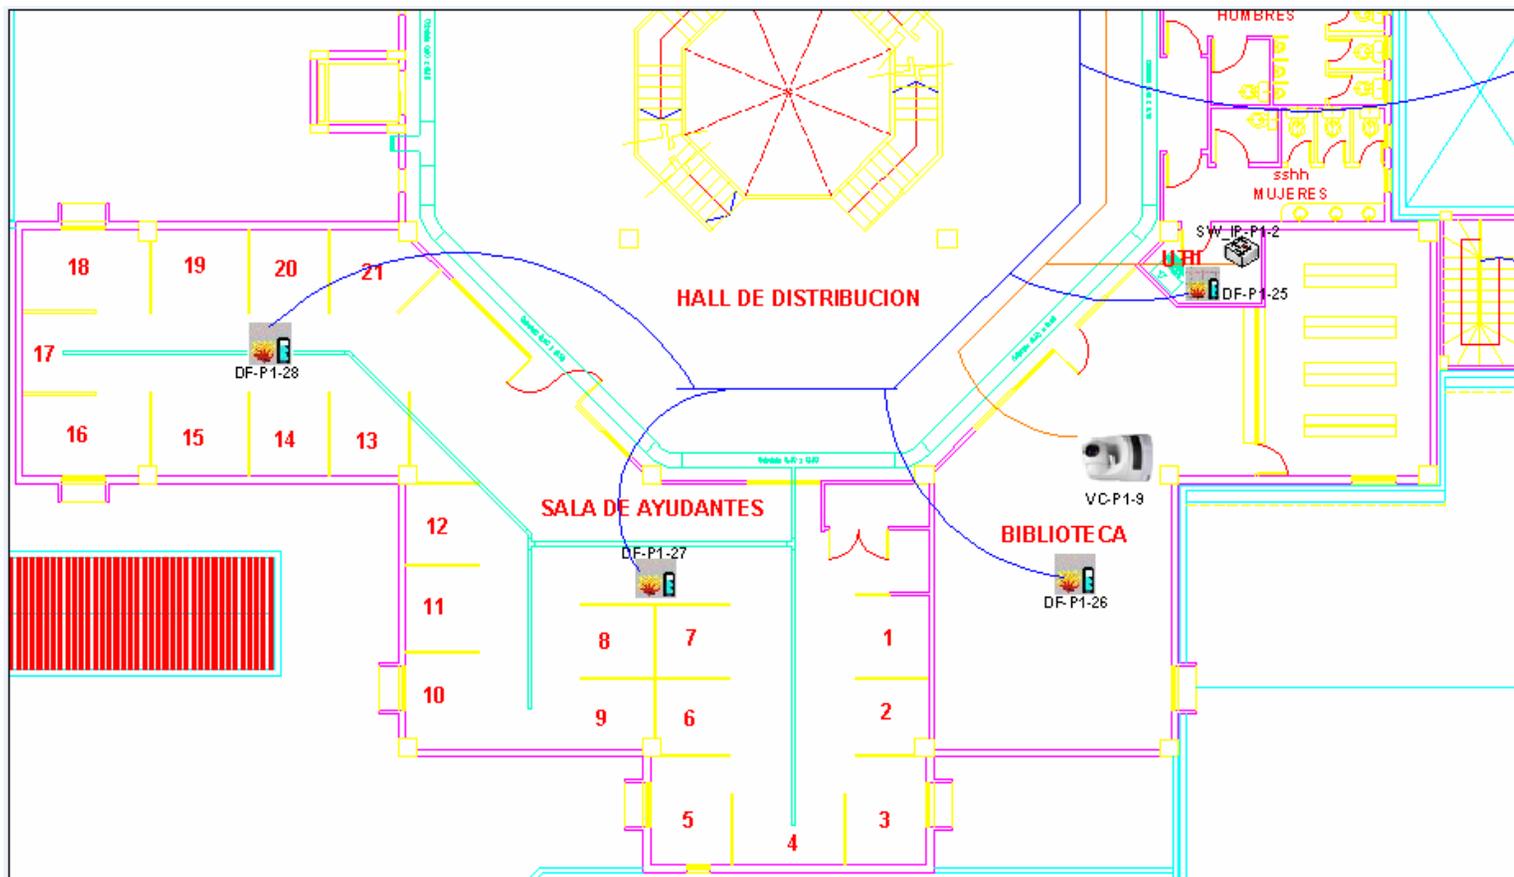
PLANO SEGURIDAD PRIMER PISO SECCION 2
